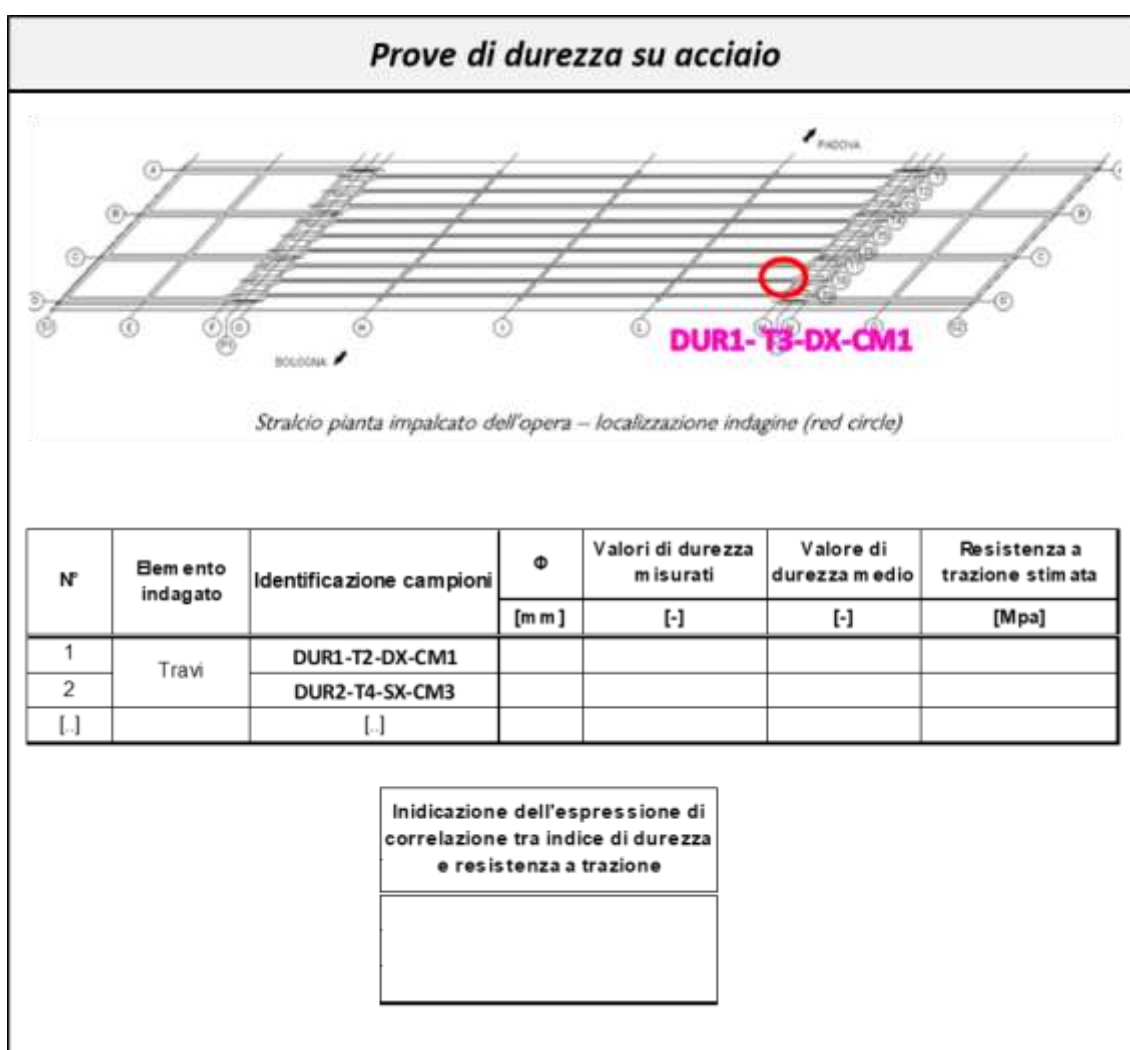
Ubicazione prove in pianta e documentazione fotografica – prove di durezza acciaio
